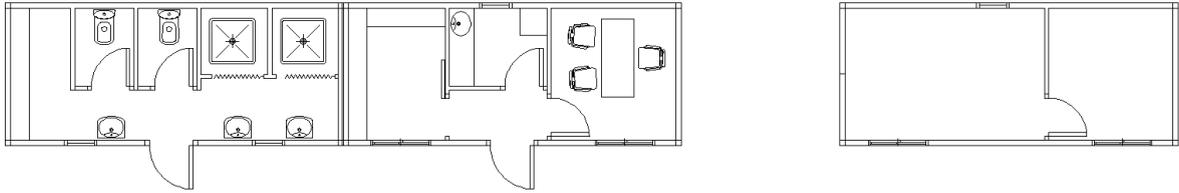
Proposta de *layout* para o canteiro de obras
